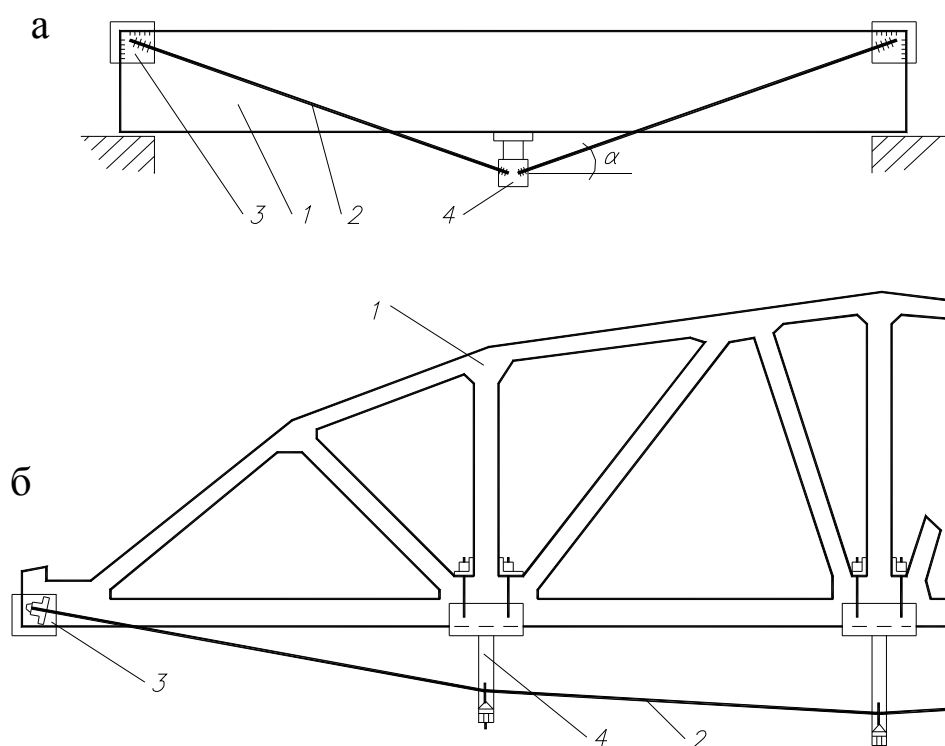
Усиление конструкций: *а* – шпренгелем; *б* – шарнирно-стержневой цепью; 1 – усиливаемая конструкция, 2 – ветви шпренгеля или цепи, 3 – анкерное устройство, 4 – стойка-оттяжка
